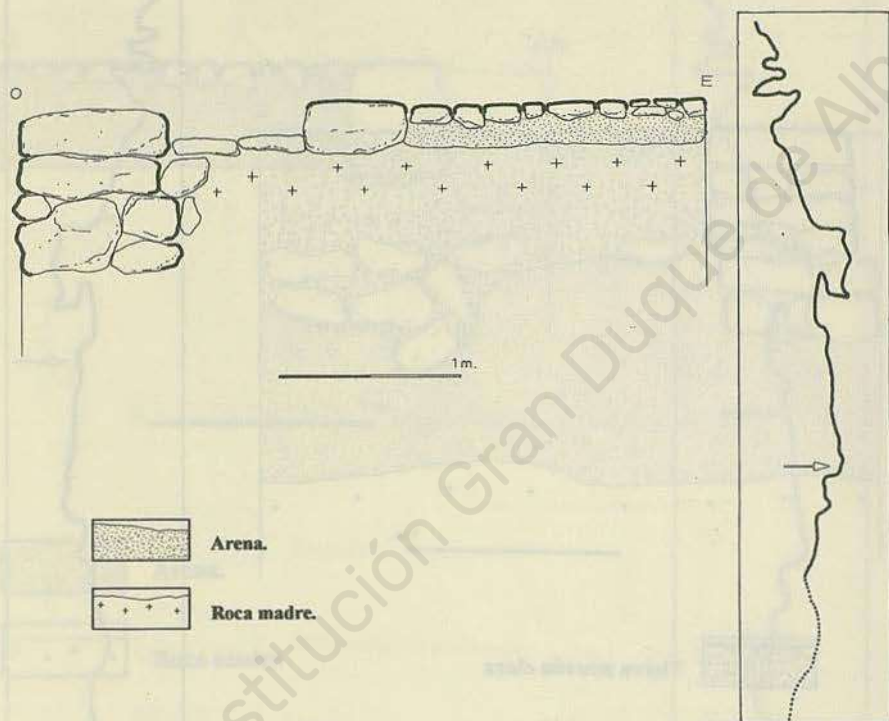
Calzada del Puerto del Pico. Cata 5. Perfil Oeste-Este.
